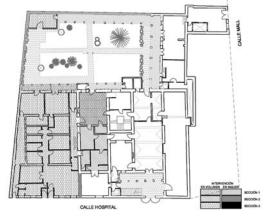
Plano de la planta baja, con indicación de las diferentes intervenciones (Jordi Salvat)
